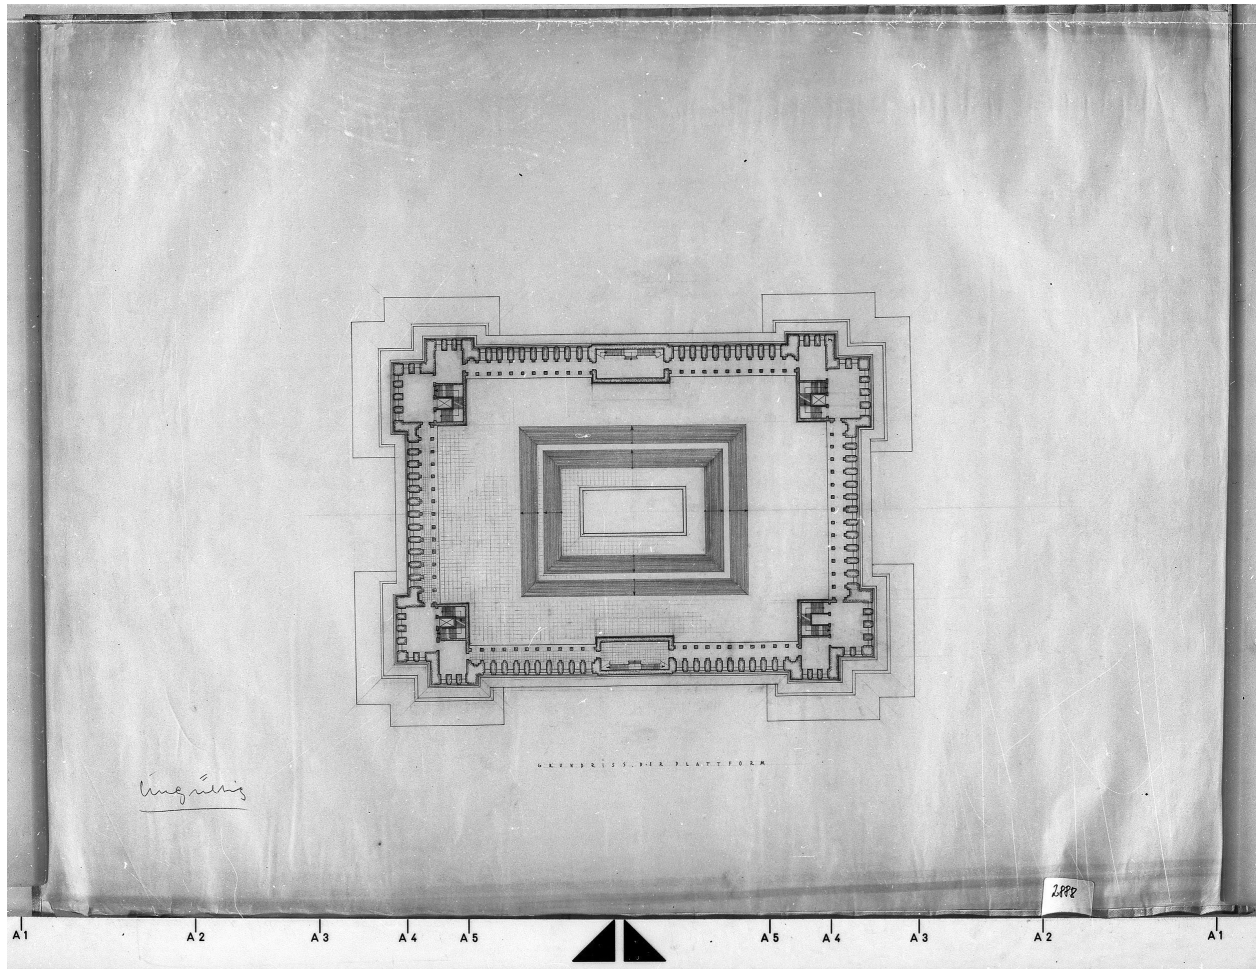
Büro Speer. “Grundriss der Plattform.” Büro Speer Pläne, 2931, Büro Speer Pläne, 2888.
